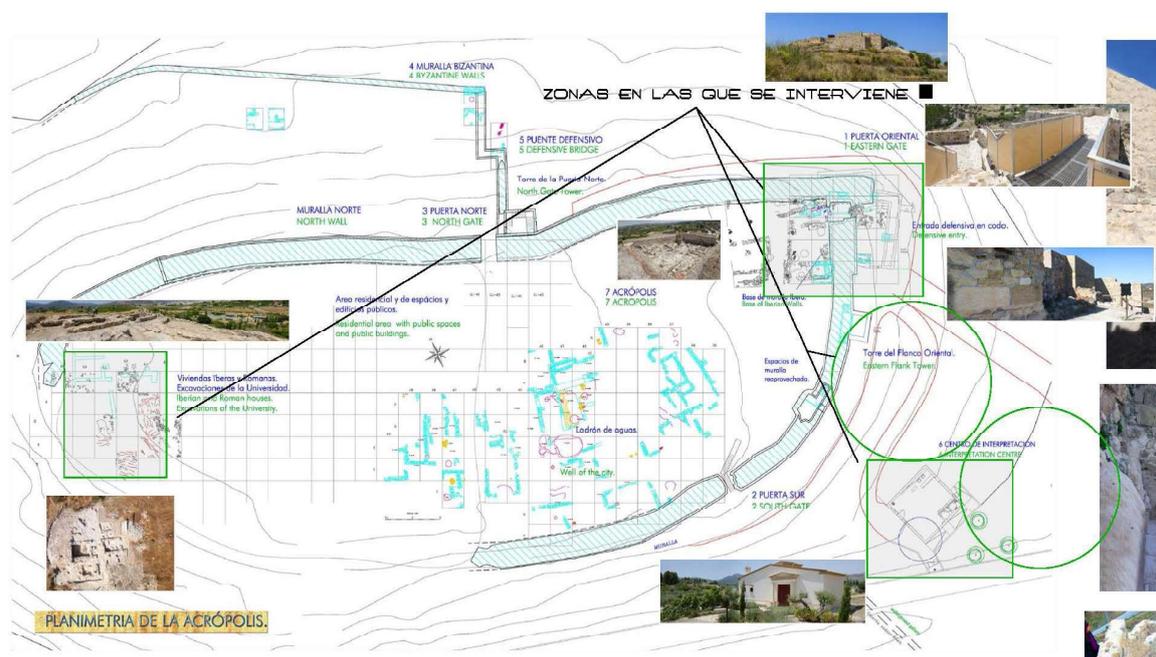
Planimetría del cerro durante la intervención en la puerta oriental.
